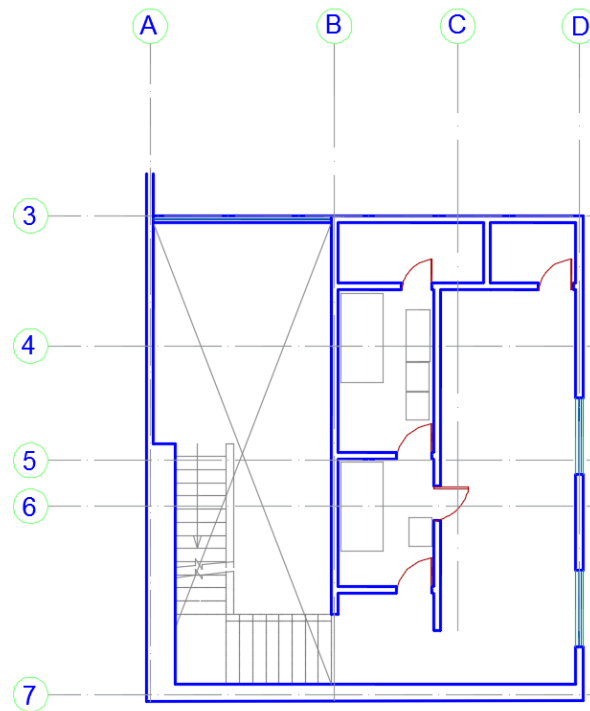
Planta arquitectónica actual del mezzanine. Fuente: Sociedad de cirugía de Bogotá- Hospital San José
